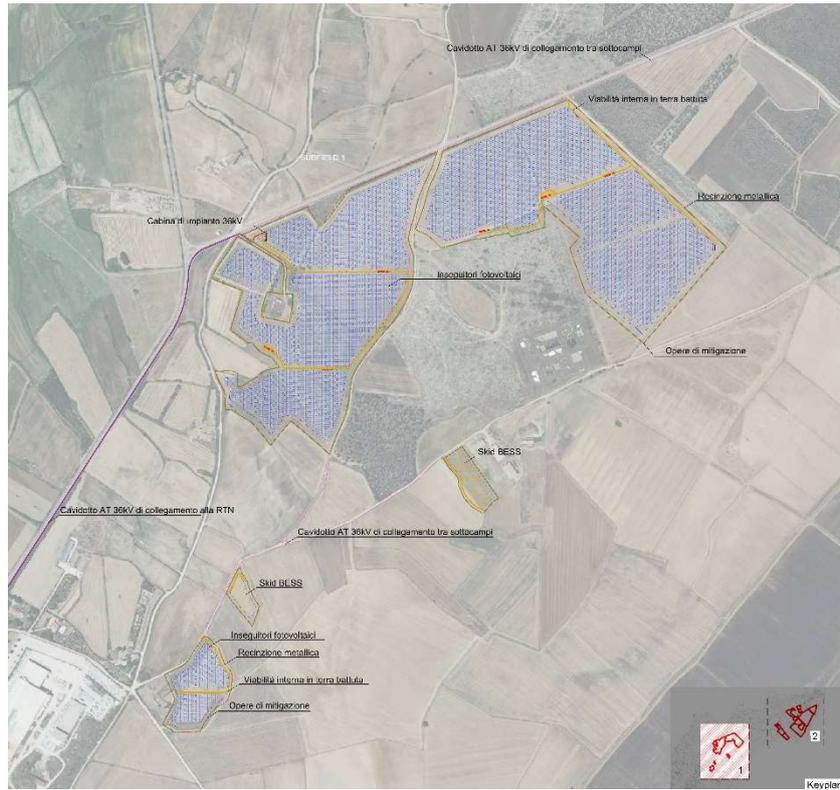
Layout di impianto Area OVEST - (rif: ICA_103_Tav09_Layout impianto su ortofoto)
